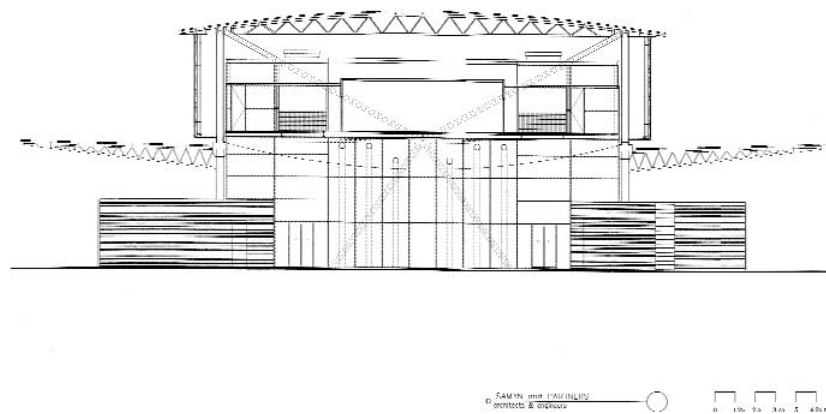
Sezione trasversale sulle pensiline delle stazioni di servizio (Samyn & partners)
